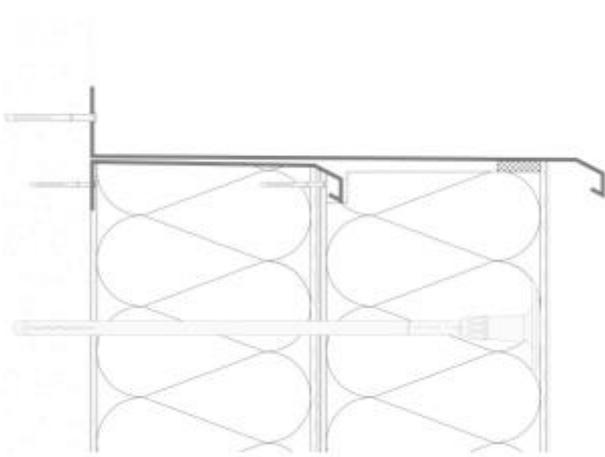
Traitement des points singuliers avec chevillage Baumit StarTrack - cas du chevillage complémentaire avec chevilles traversantes lors de l'utilisation de PSE gris
